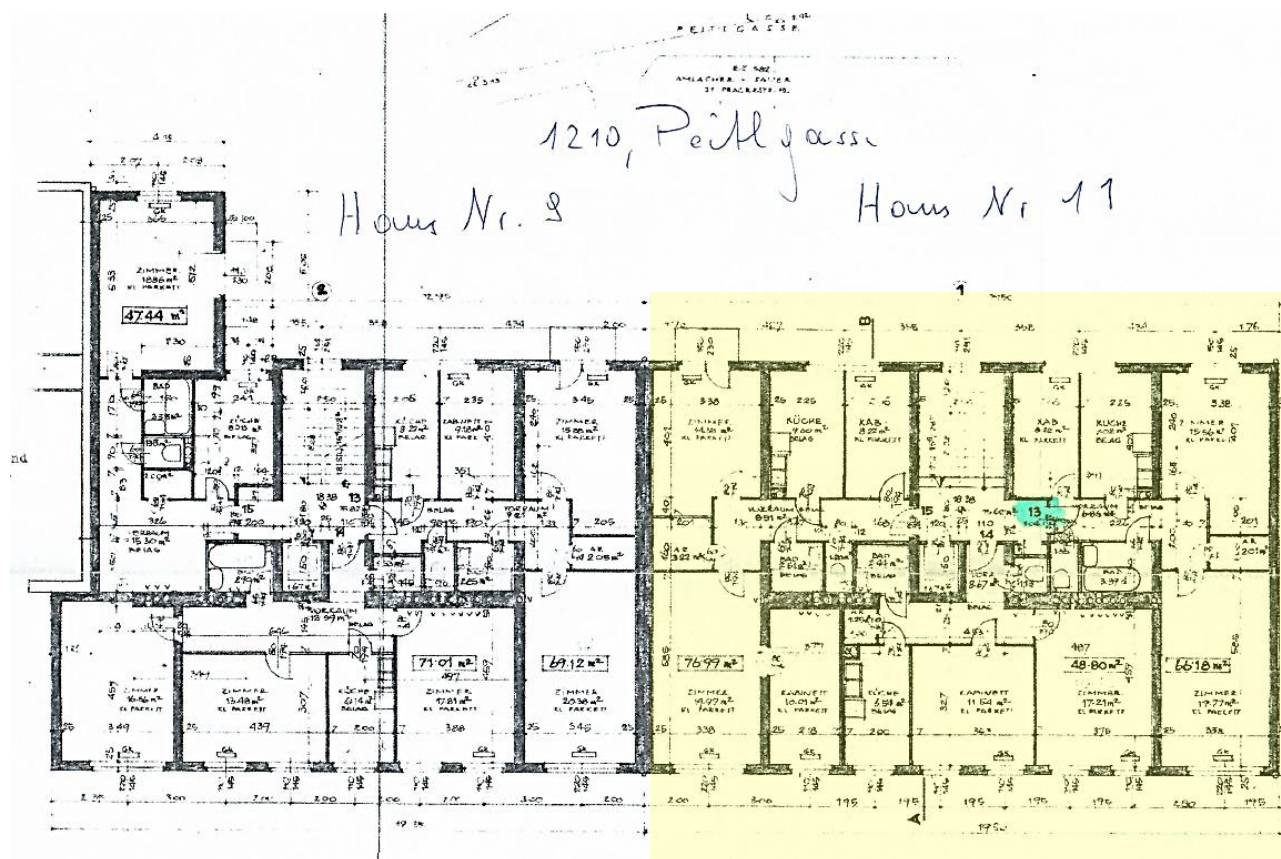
; Regelgrundriss bewertungsgegenständliche LIE gelb markiert Q: Hausverwaltung
